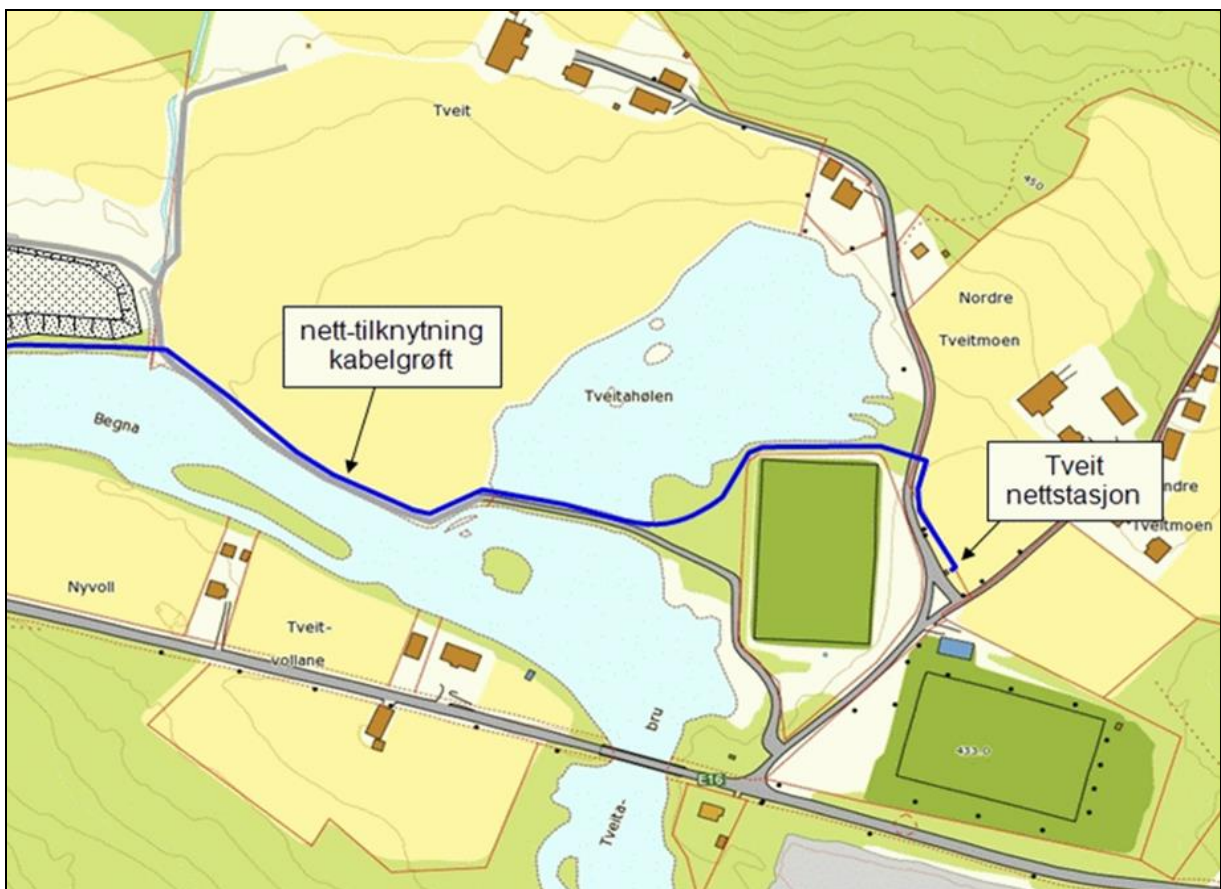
Planskisse kraftstasjonsområdet for Føssberge kraftverk.
